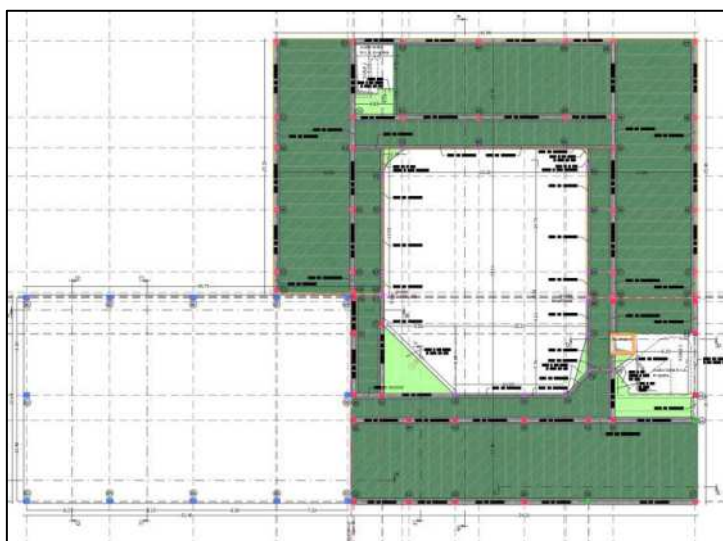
Planimetria solaio strutturale del primo piano dell'edificio scolastico
